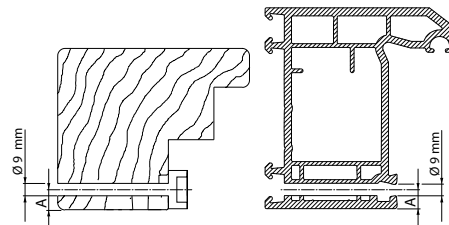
Querschnitt Holz- und Kunststoffprofil inklusive Bohrposition
